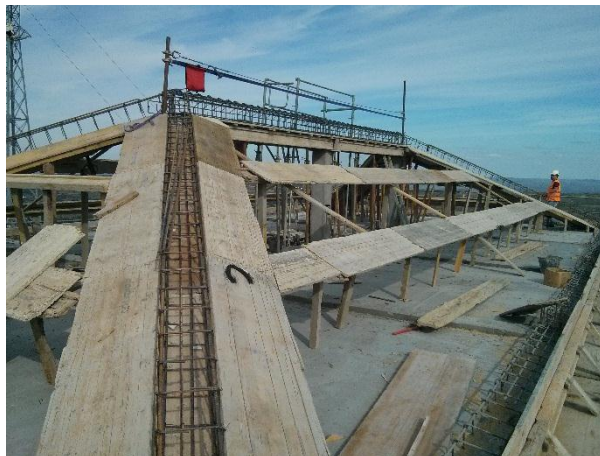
COFRAGEM DAS VIGAS E LAJES
